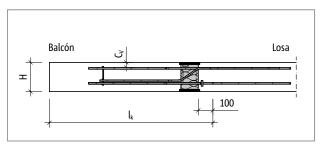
Schöck Isokorb® XT tipo C: Sistema estático
